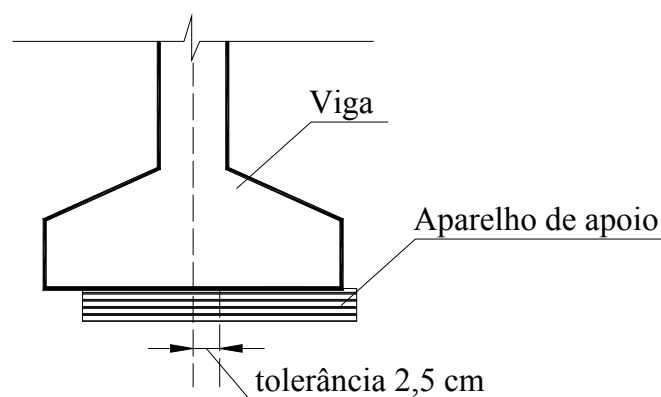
Excentricidade entre o aparelho de apoio e a viga
